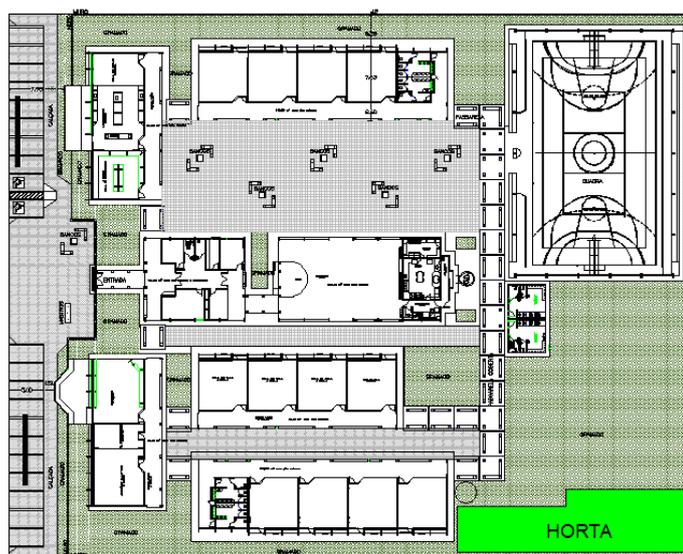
Planta baixa e horta projetada para a escola Maria Busato.
